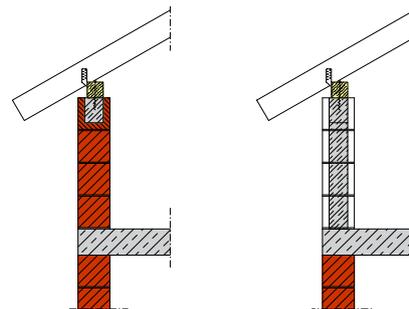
Drempel – Schnitte durch Mauerwerk und Kragstütze
